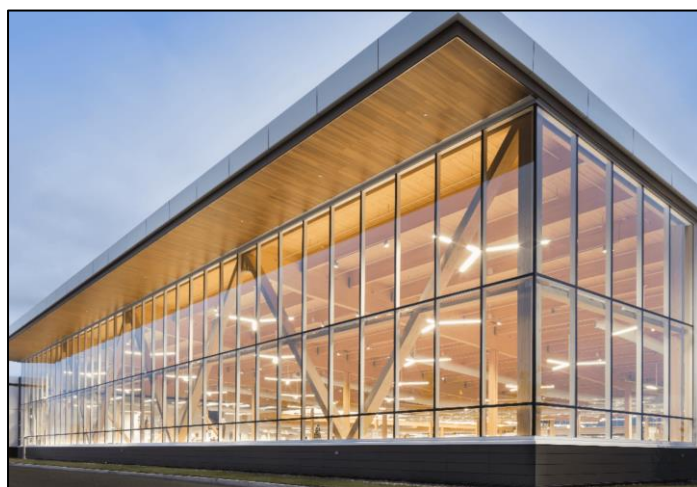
Exemple d'un bâtiment à ossature en bois (source : <https://cecobois.com/systemes-structuraux/ossature-legere-en-bois>)
